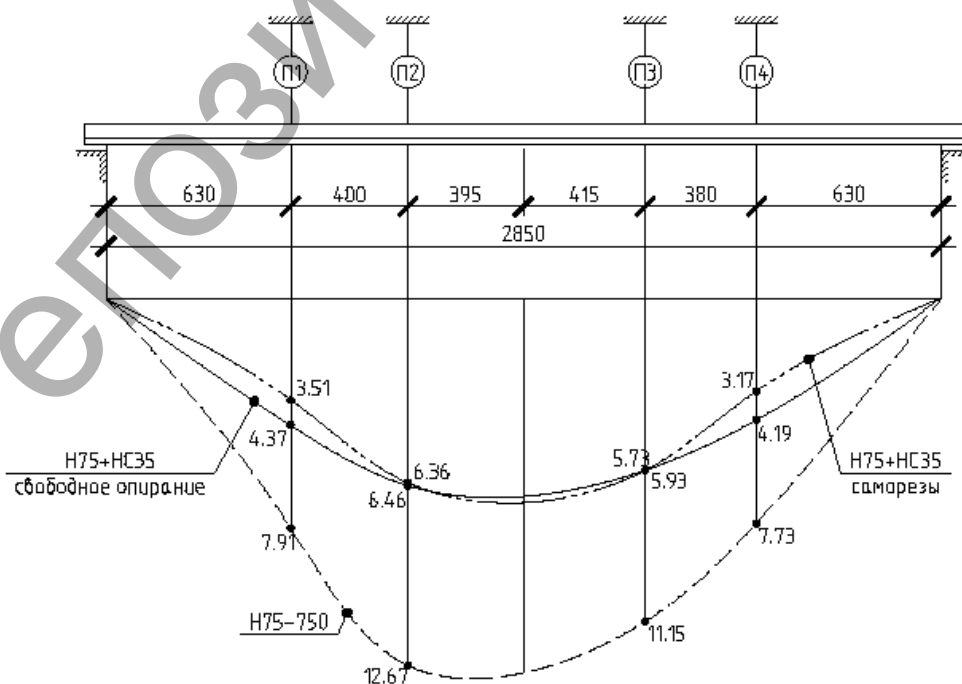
Вертикальные перемещения от испытательной нагрузки
